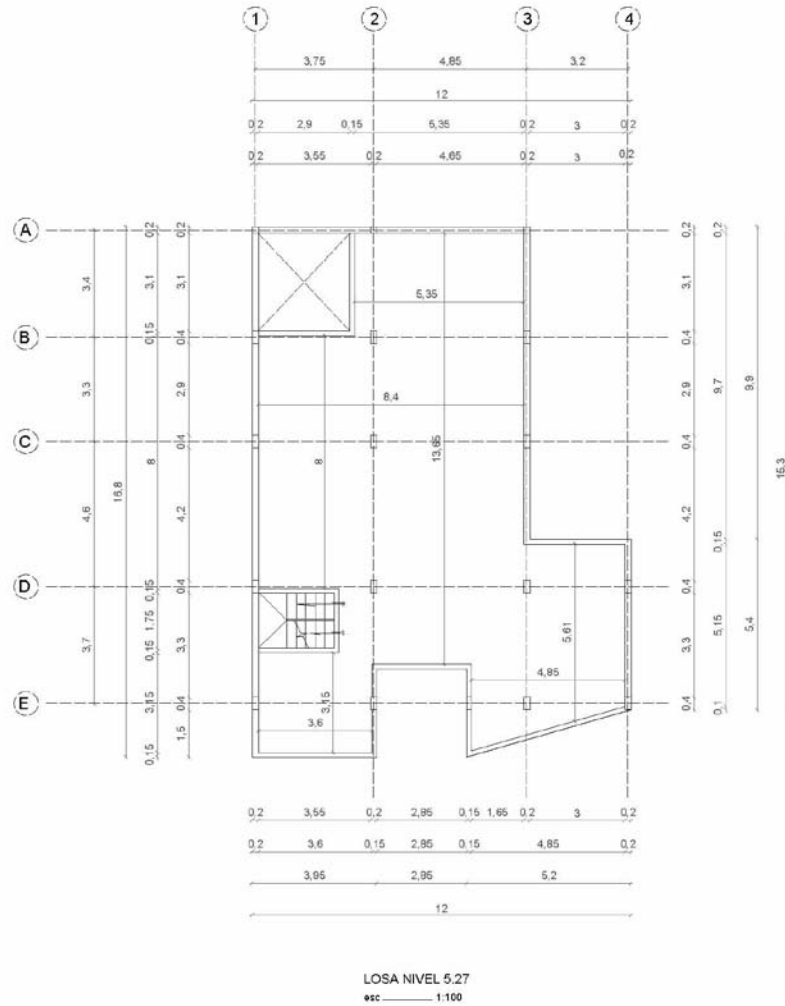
Plano acotado de la construcción existente donde se ubicara el proyecto
